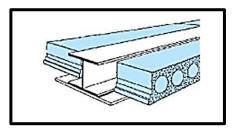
Dalle alvéolée précontrainte intégrée à une poutre en acier.
